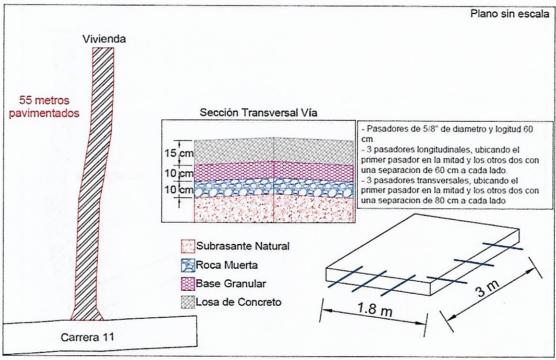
Plano y sección transversal carrera 12 Sur entre calles 3 y 4
